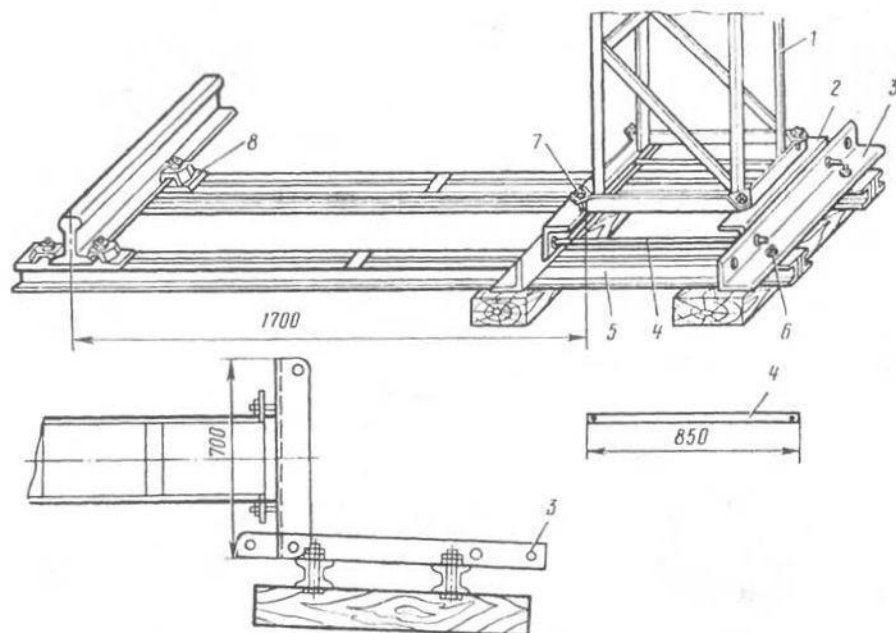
Конструкция "фундамента" с креплением за рельс:
